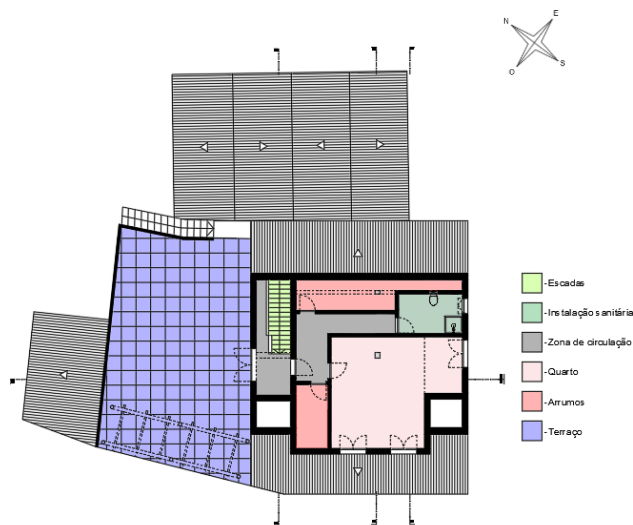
Planta existente do piso 1, autora: Maria Santos
